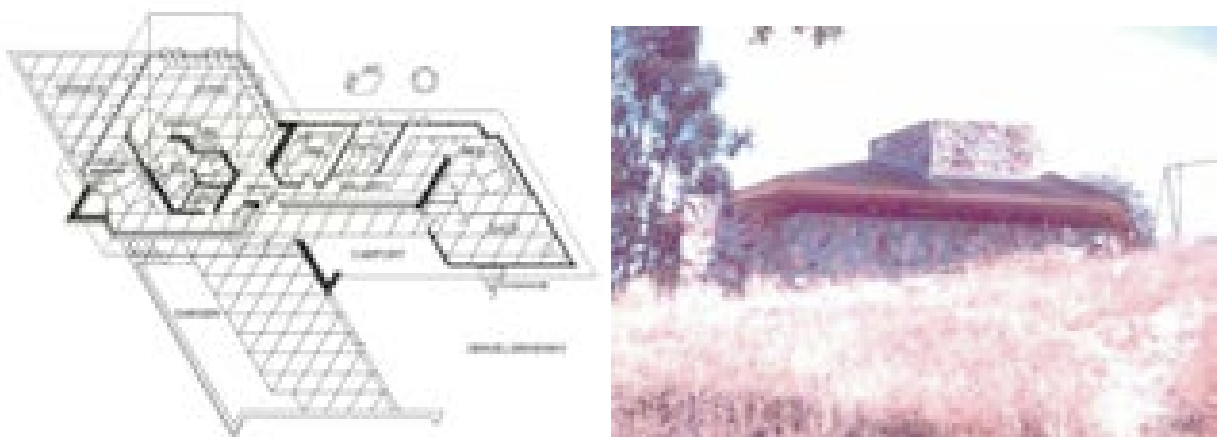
Planimetria e vista esterna della Berger House¹⁹⁴
